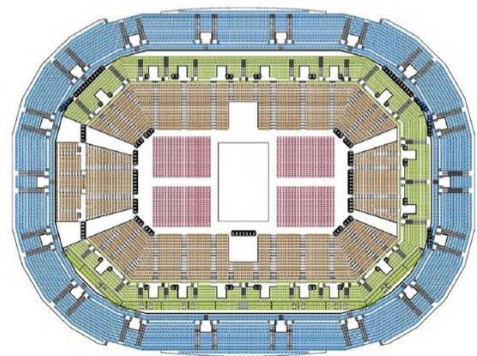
Arena Zagreb, Загреб. Видовой кадр, план 1-го этажа
